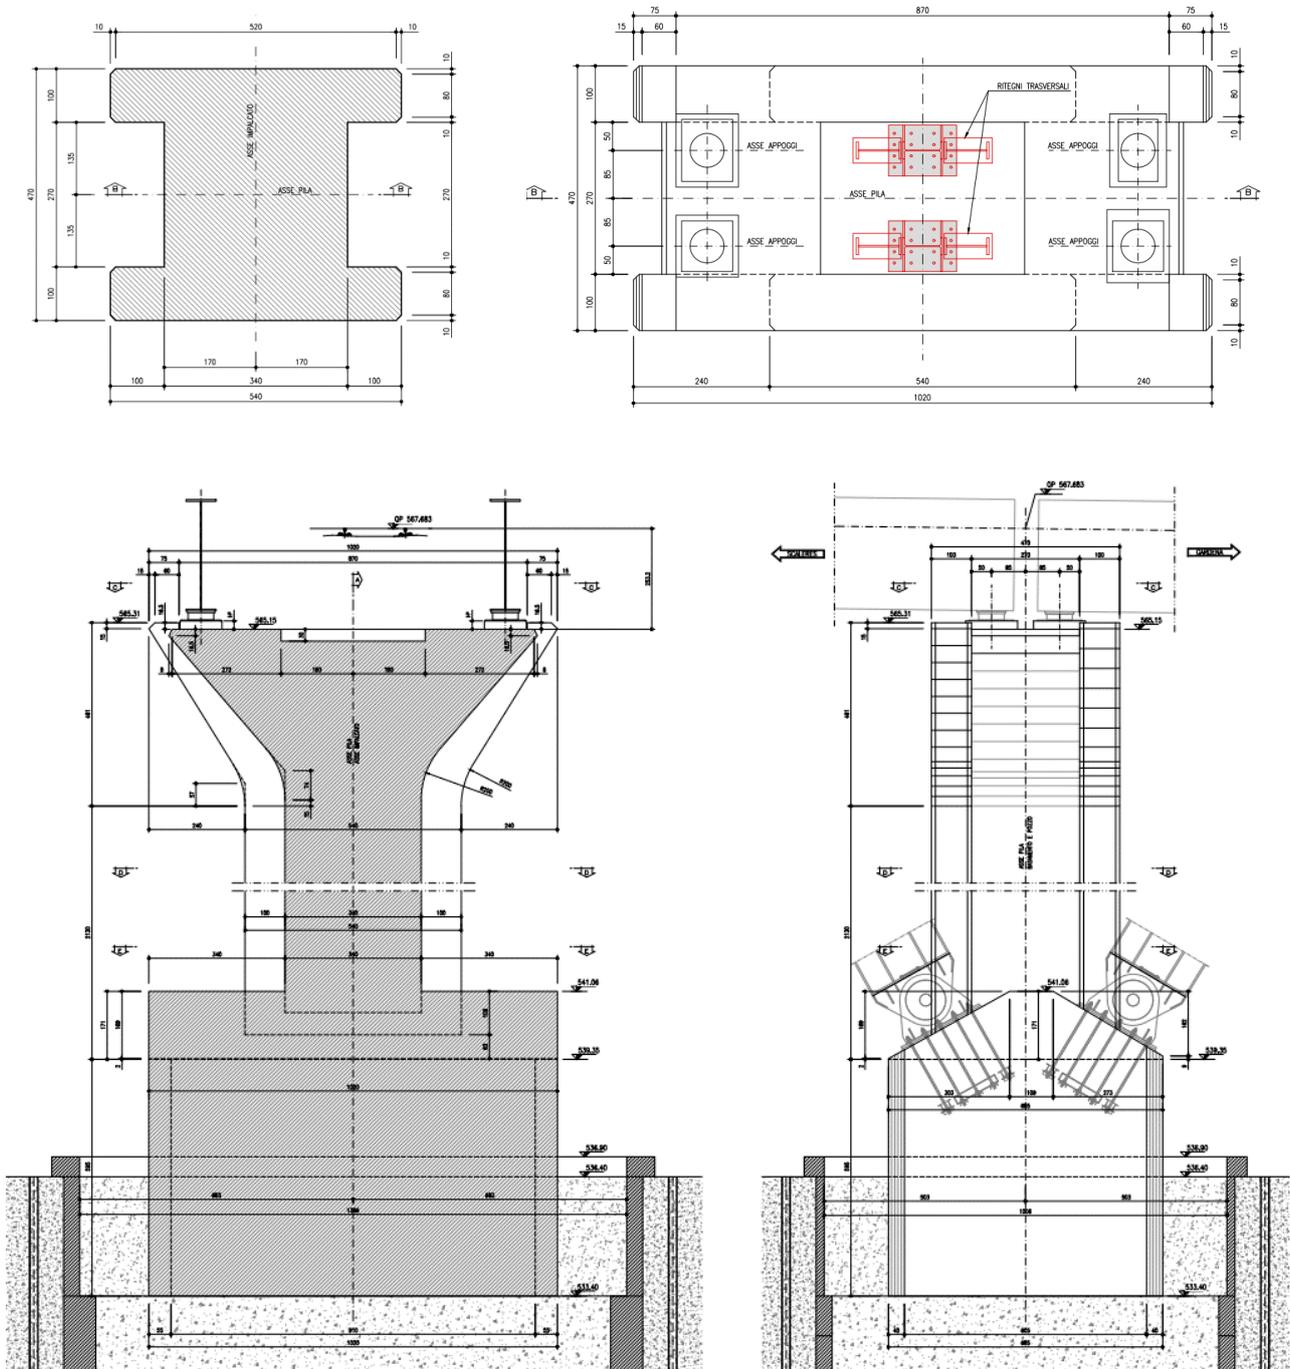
Pila tipica - Sezione fuso, pianta pulvino, sezione trasversale e prospetto laterale
